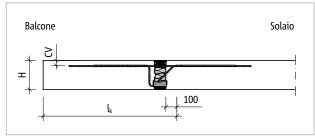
Schöck Isokorb® T tipo KL-M1 − M7: sistema statico
